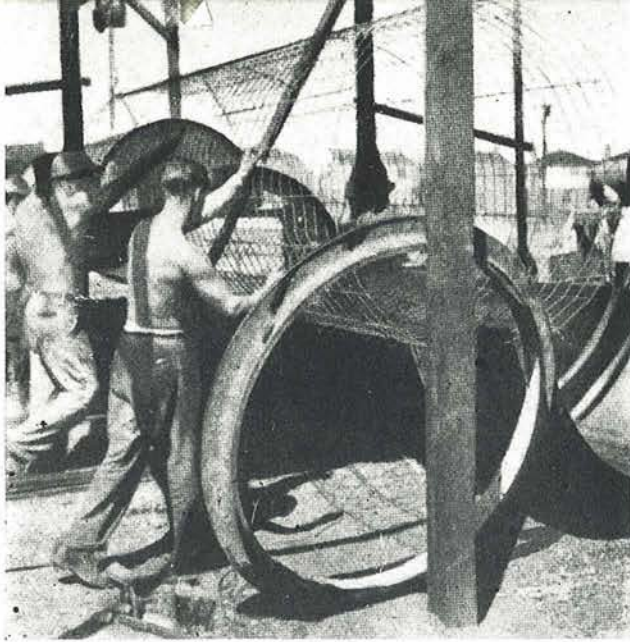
Colocación en el molde de una jaula de alambre pre-atirantado, destinado a reforzar las paredes de hormigón de una tubería de 4'90 m. de largo y 1'40 m. de diámetro, calculada para una presión de 7'6 Kgs./cm.² La malla de la jaula es de 10×20 cm. y está constituida por alambre del núm. 7 y núm. 4.
